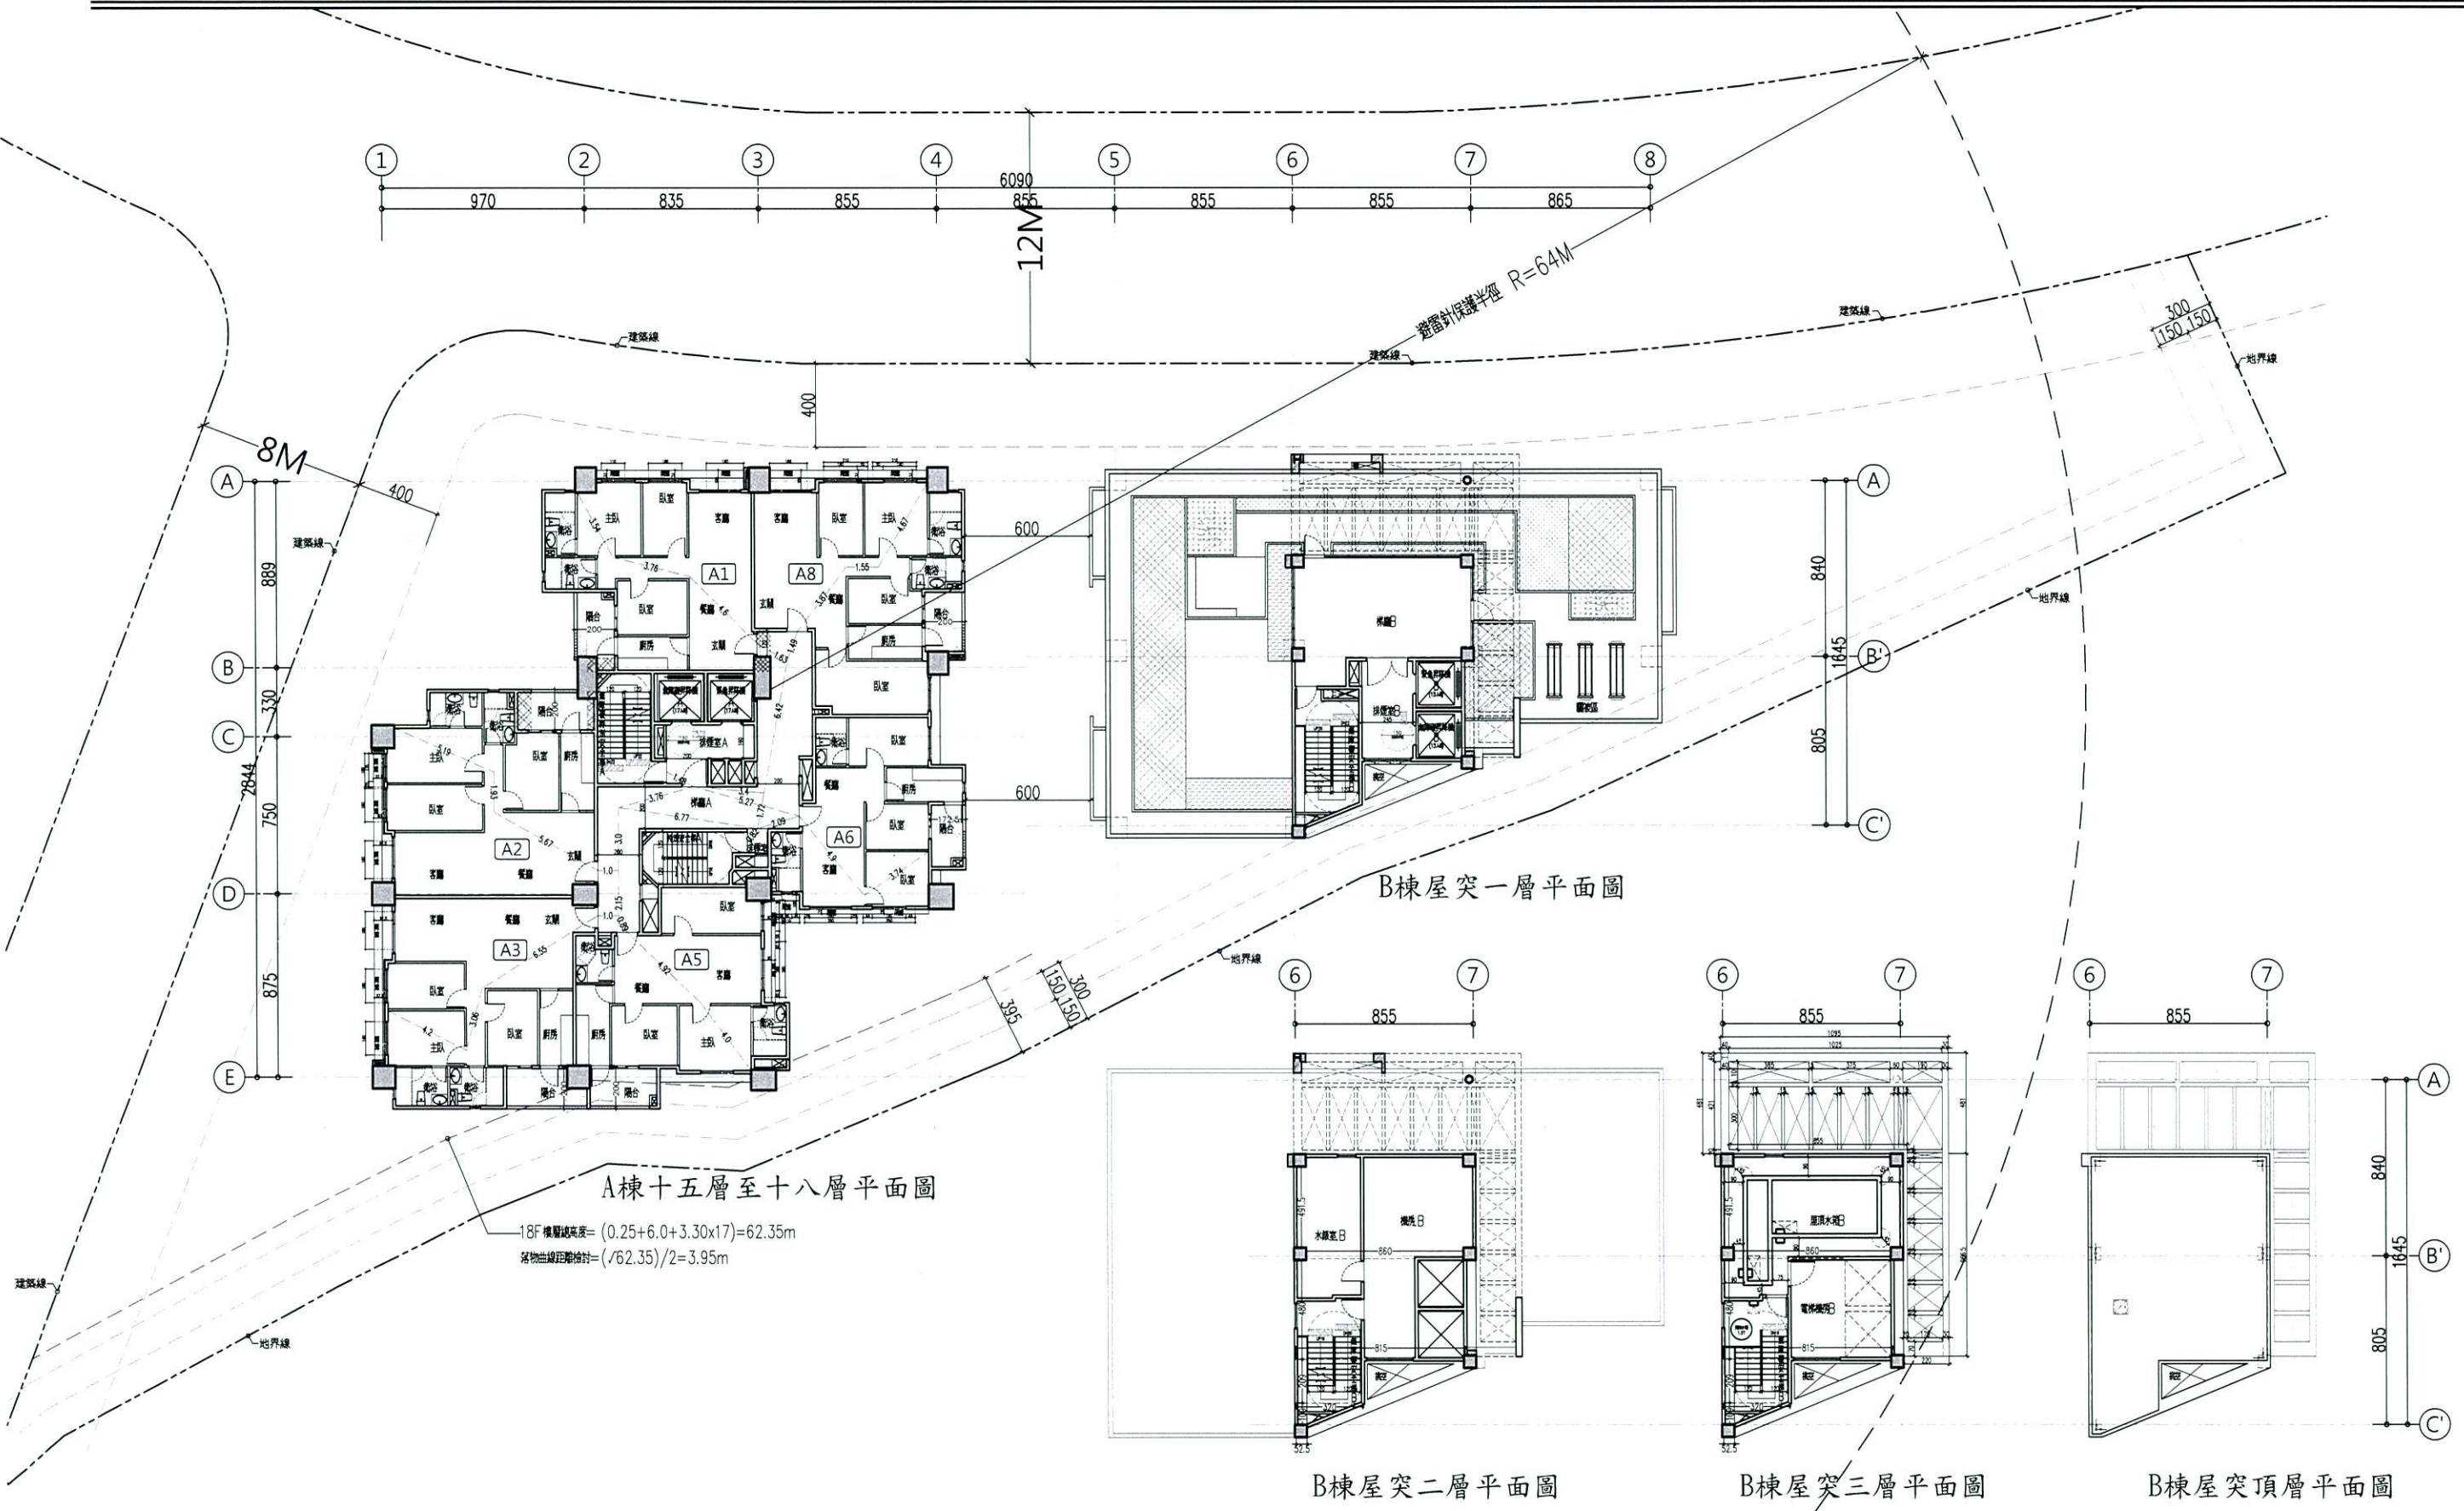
A棟十五層至十八層、B棟屋突各層平面圖
